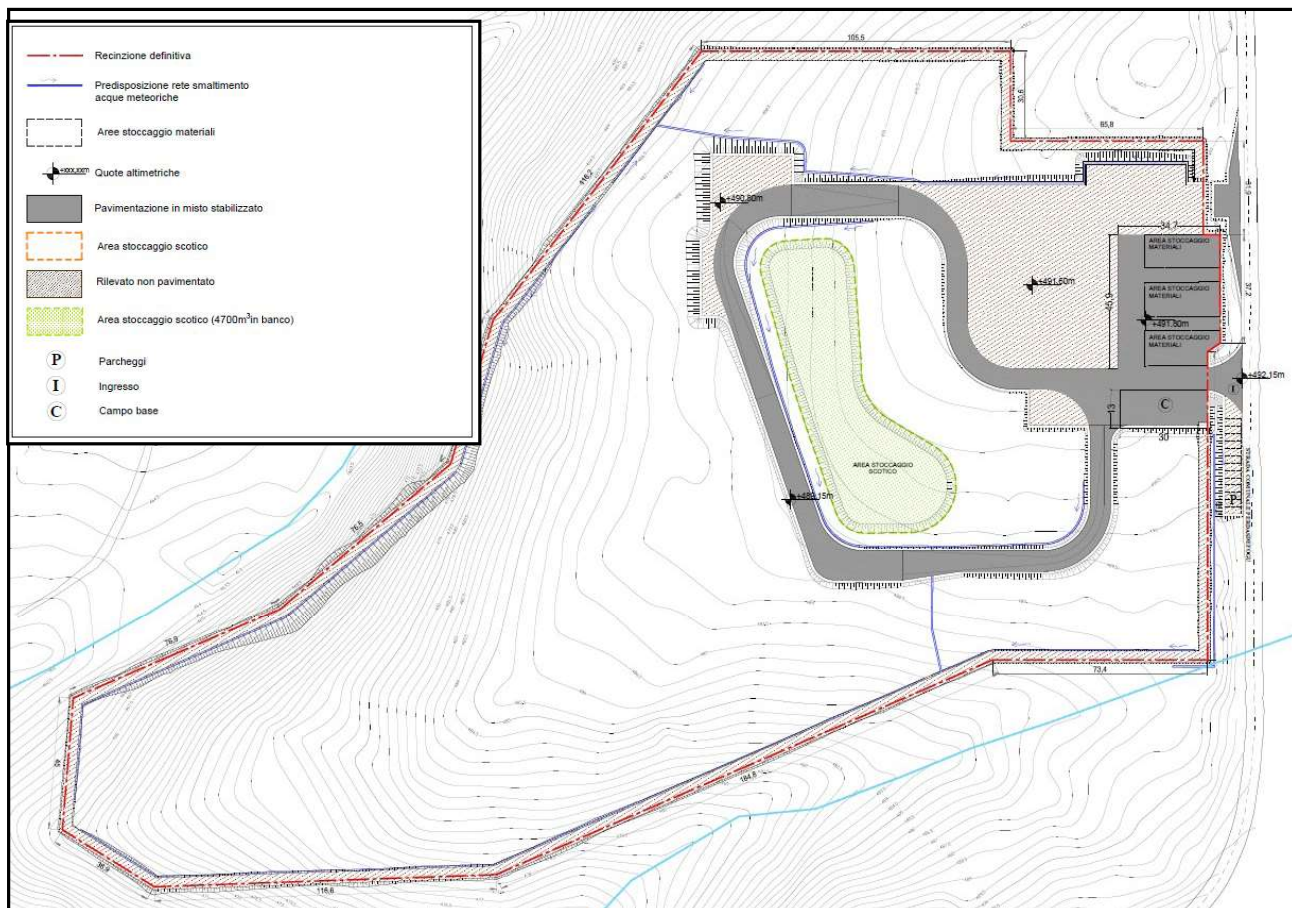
Area interessata dalla fase di pre-cantierizzazione
